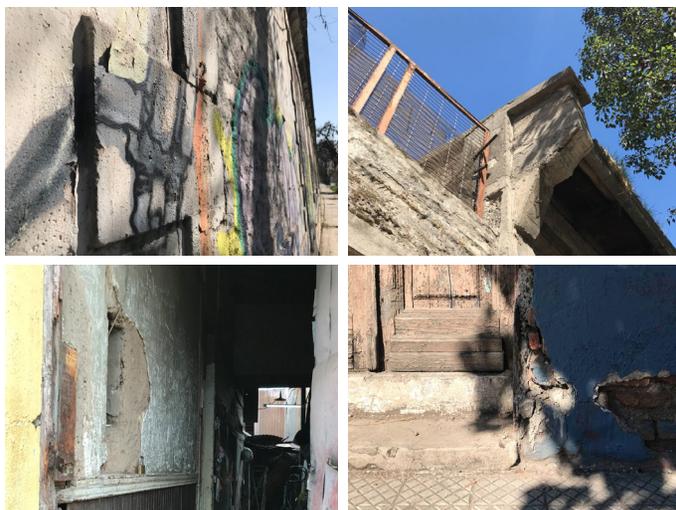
Detalle de fachada de la Ex azucarera calle Lord Cochrane, detalle remate de la Ex azucarera calle Bio Bio, pared interna deteriorada, detalle vivienda con similares características a la tipología de Huemul I.
